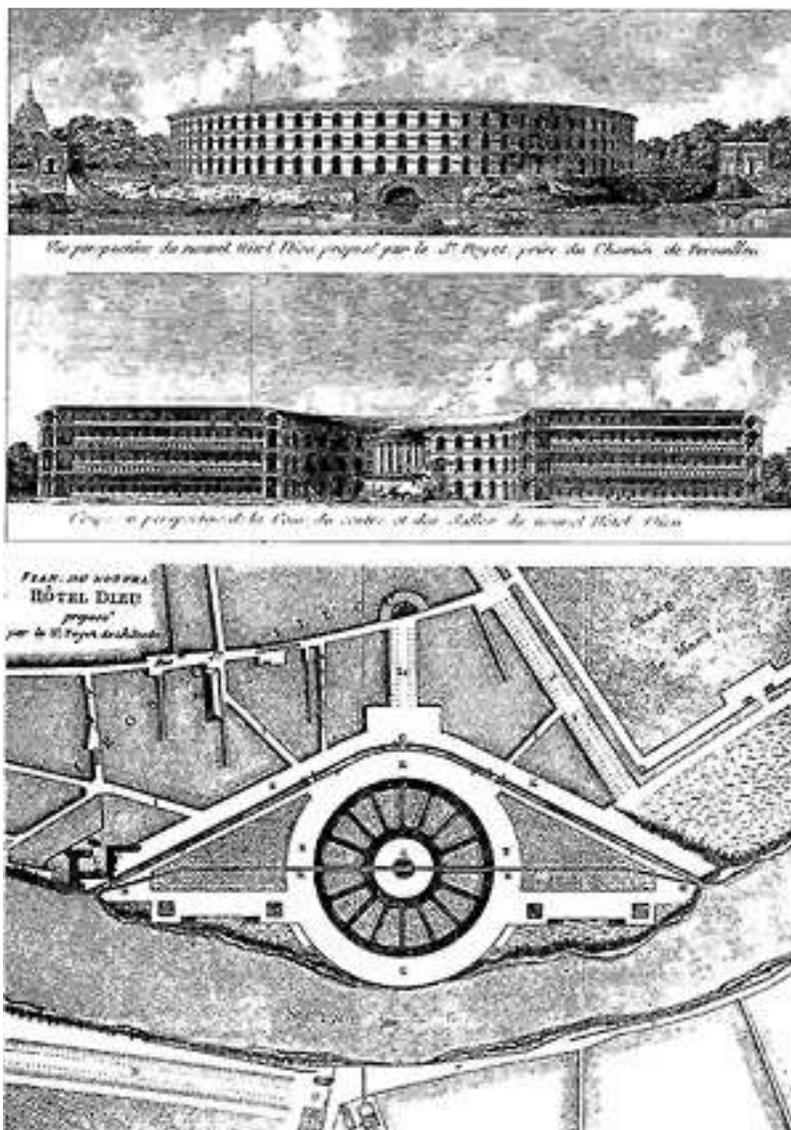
Projeto para o Hôtel-Dieu, Fachadas e Planta Baixa, por Poyet, Paris, 1785.
